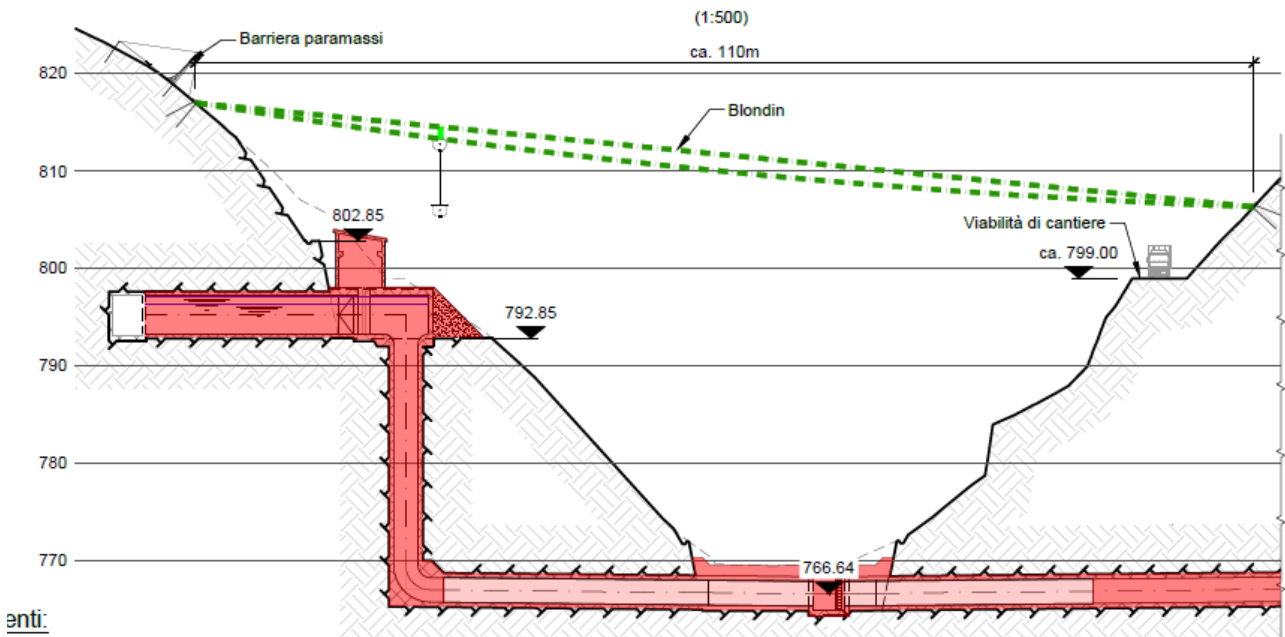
sezione schematica del sifone con indicazione del blondin (elaborato 10222-C-OR-KOR-C-DS-566)
